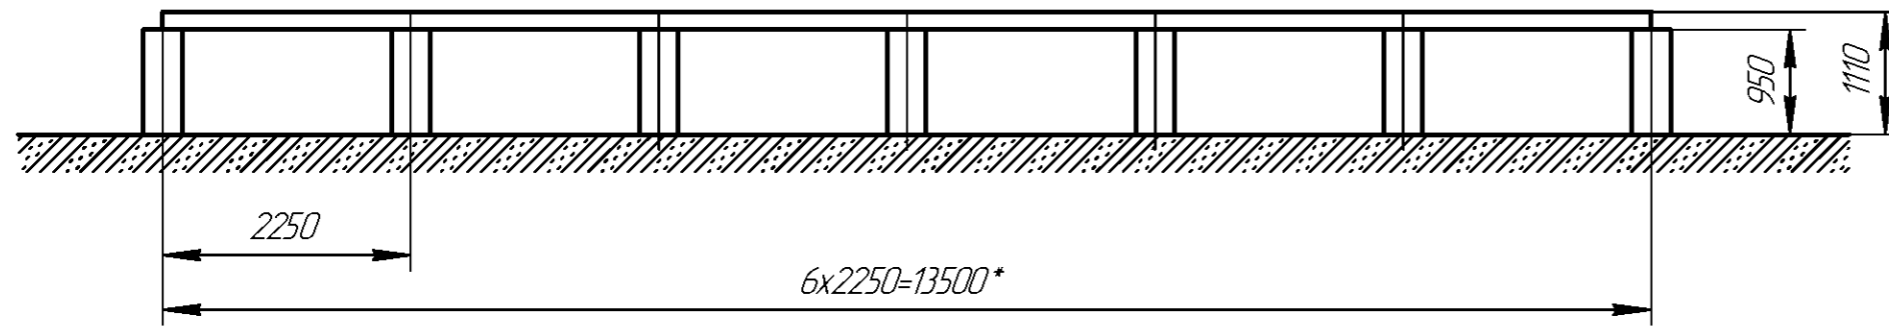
Рекомендации по проектированию фундамента для КРПЗ-10 с двухрядным расположением ячеек.
